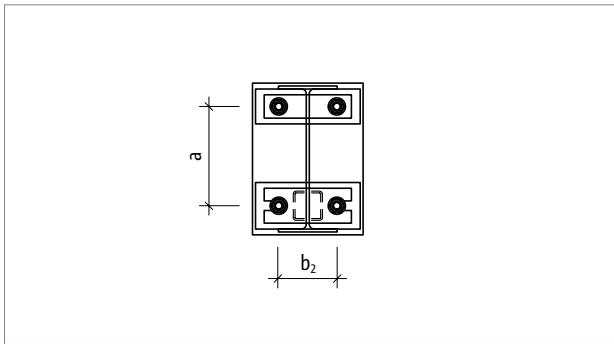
Platine frontale affleurante T type S : calcul des valeurs géométriques d'entrée ; vue de face
